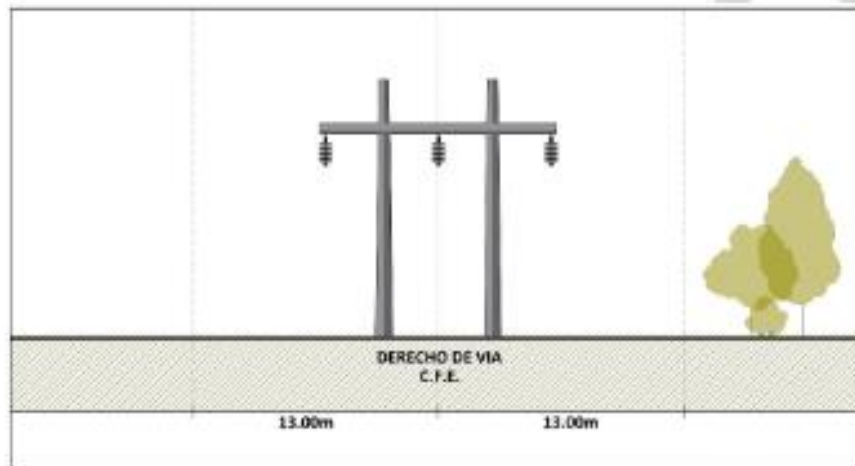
Líneas de alta tensión de 230 KV. Estructuras tipo "H" para casos propuestos sobre proyección vial.
